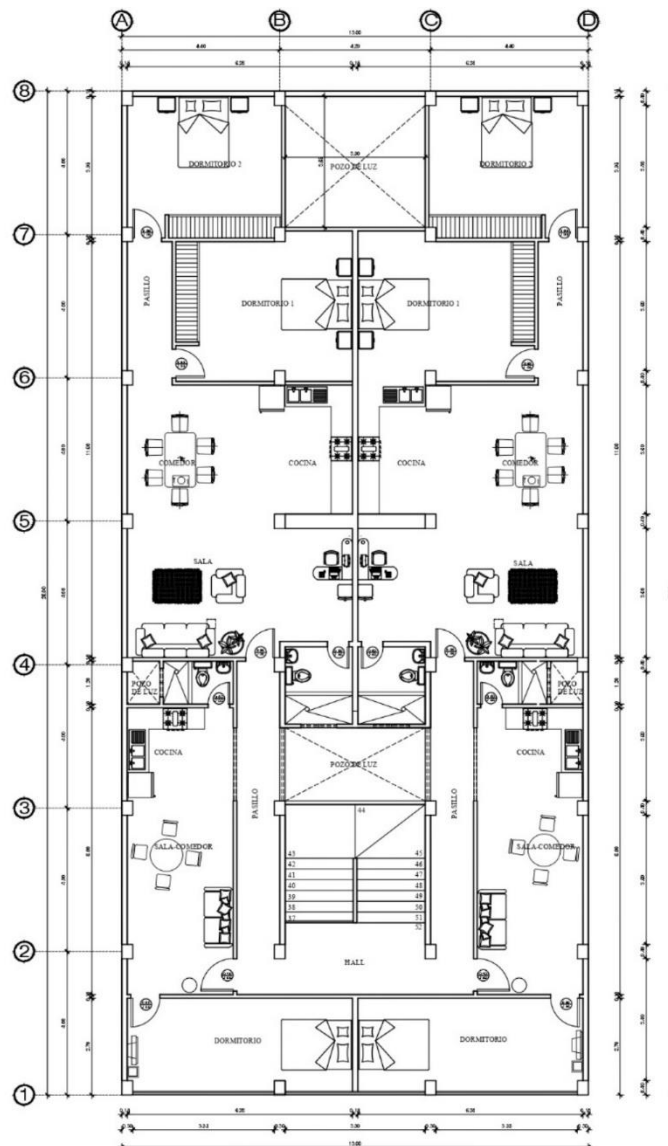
Planta arquitectónica residencial (Autores)
